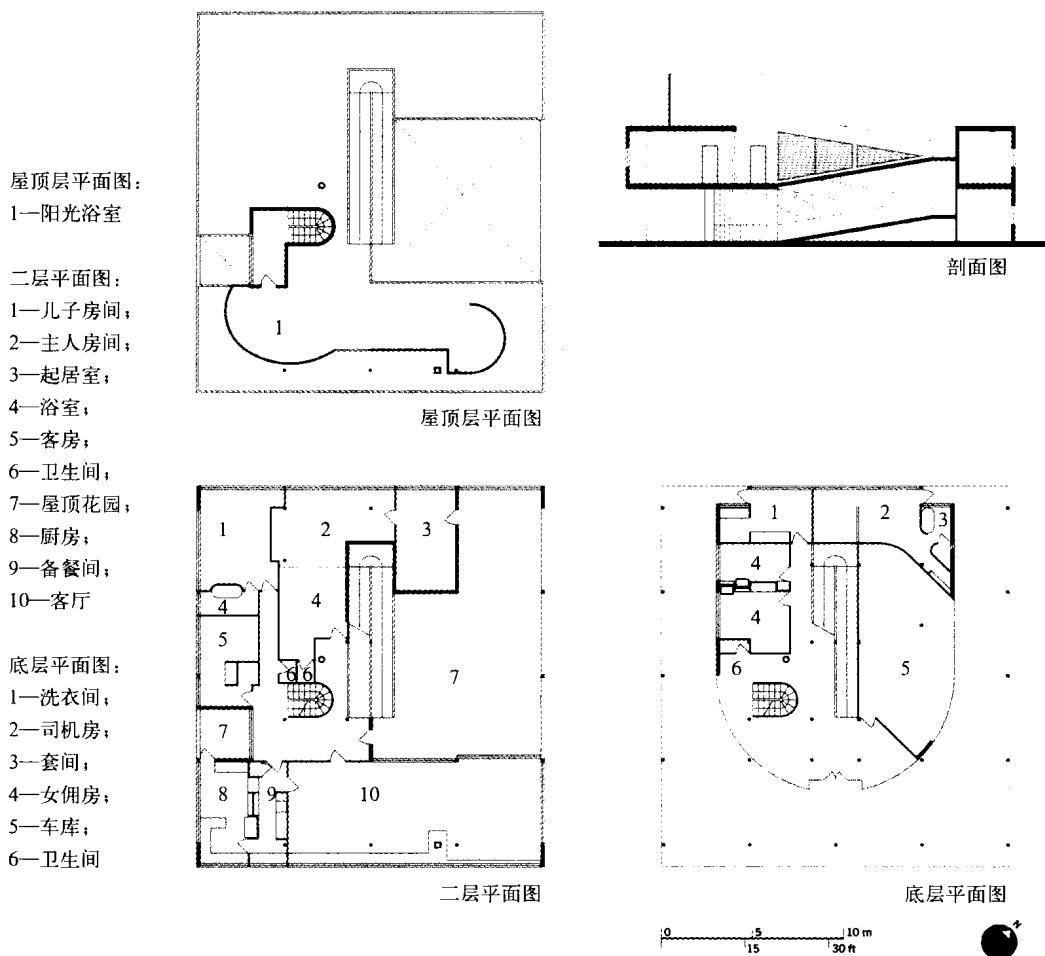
萨伏伊别墅底层、二层、屋顶层平面图与剖面图
